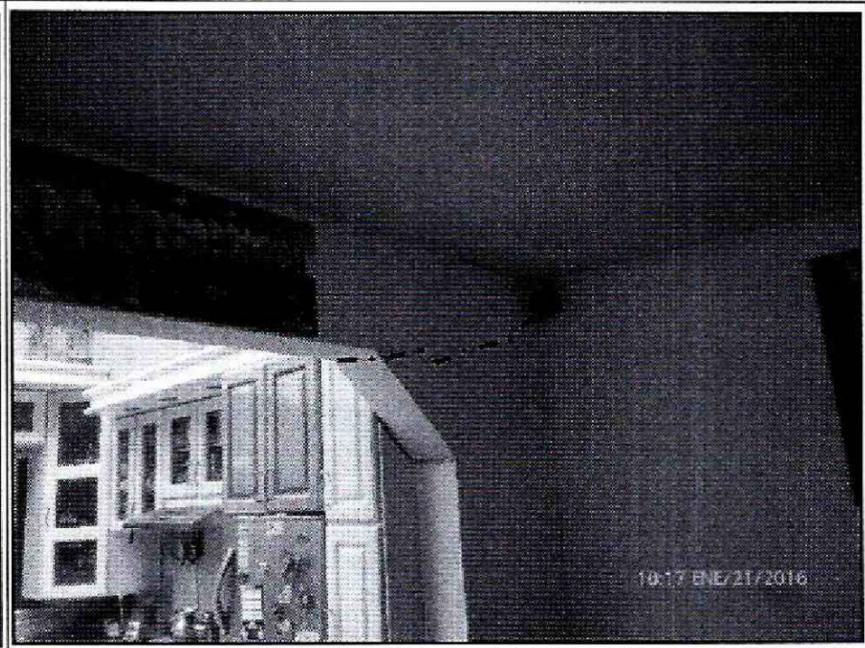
y 2. Vista de la vivienda emplazada al costado sur del predio de la Carrera 100 No. 16H-47 en el Barrio El Carmen de la Localidad de Fontibón.
